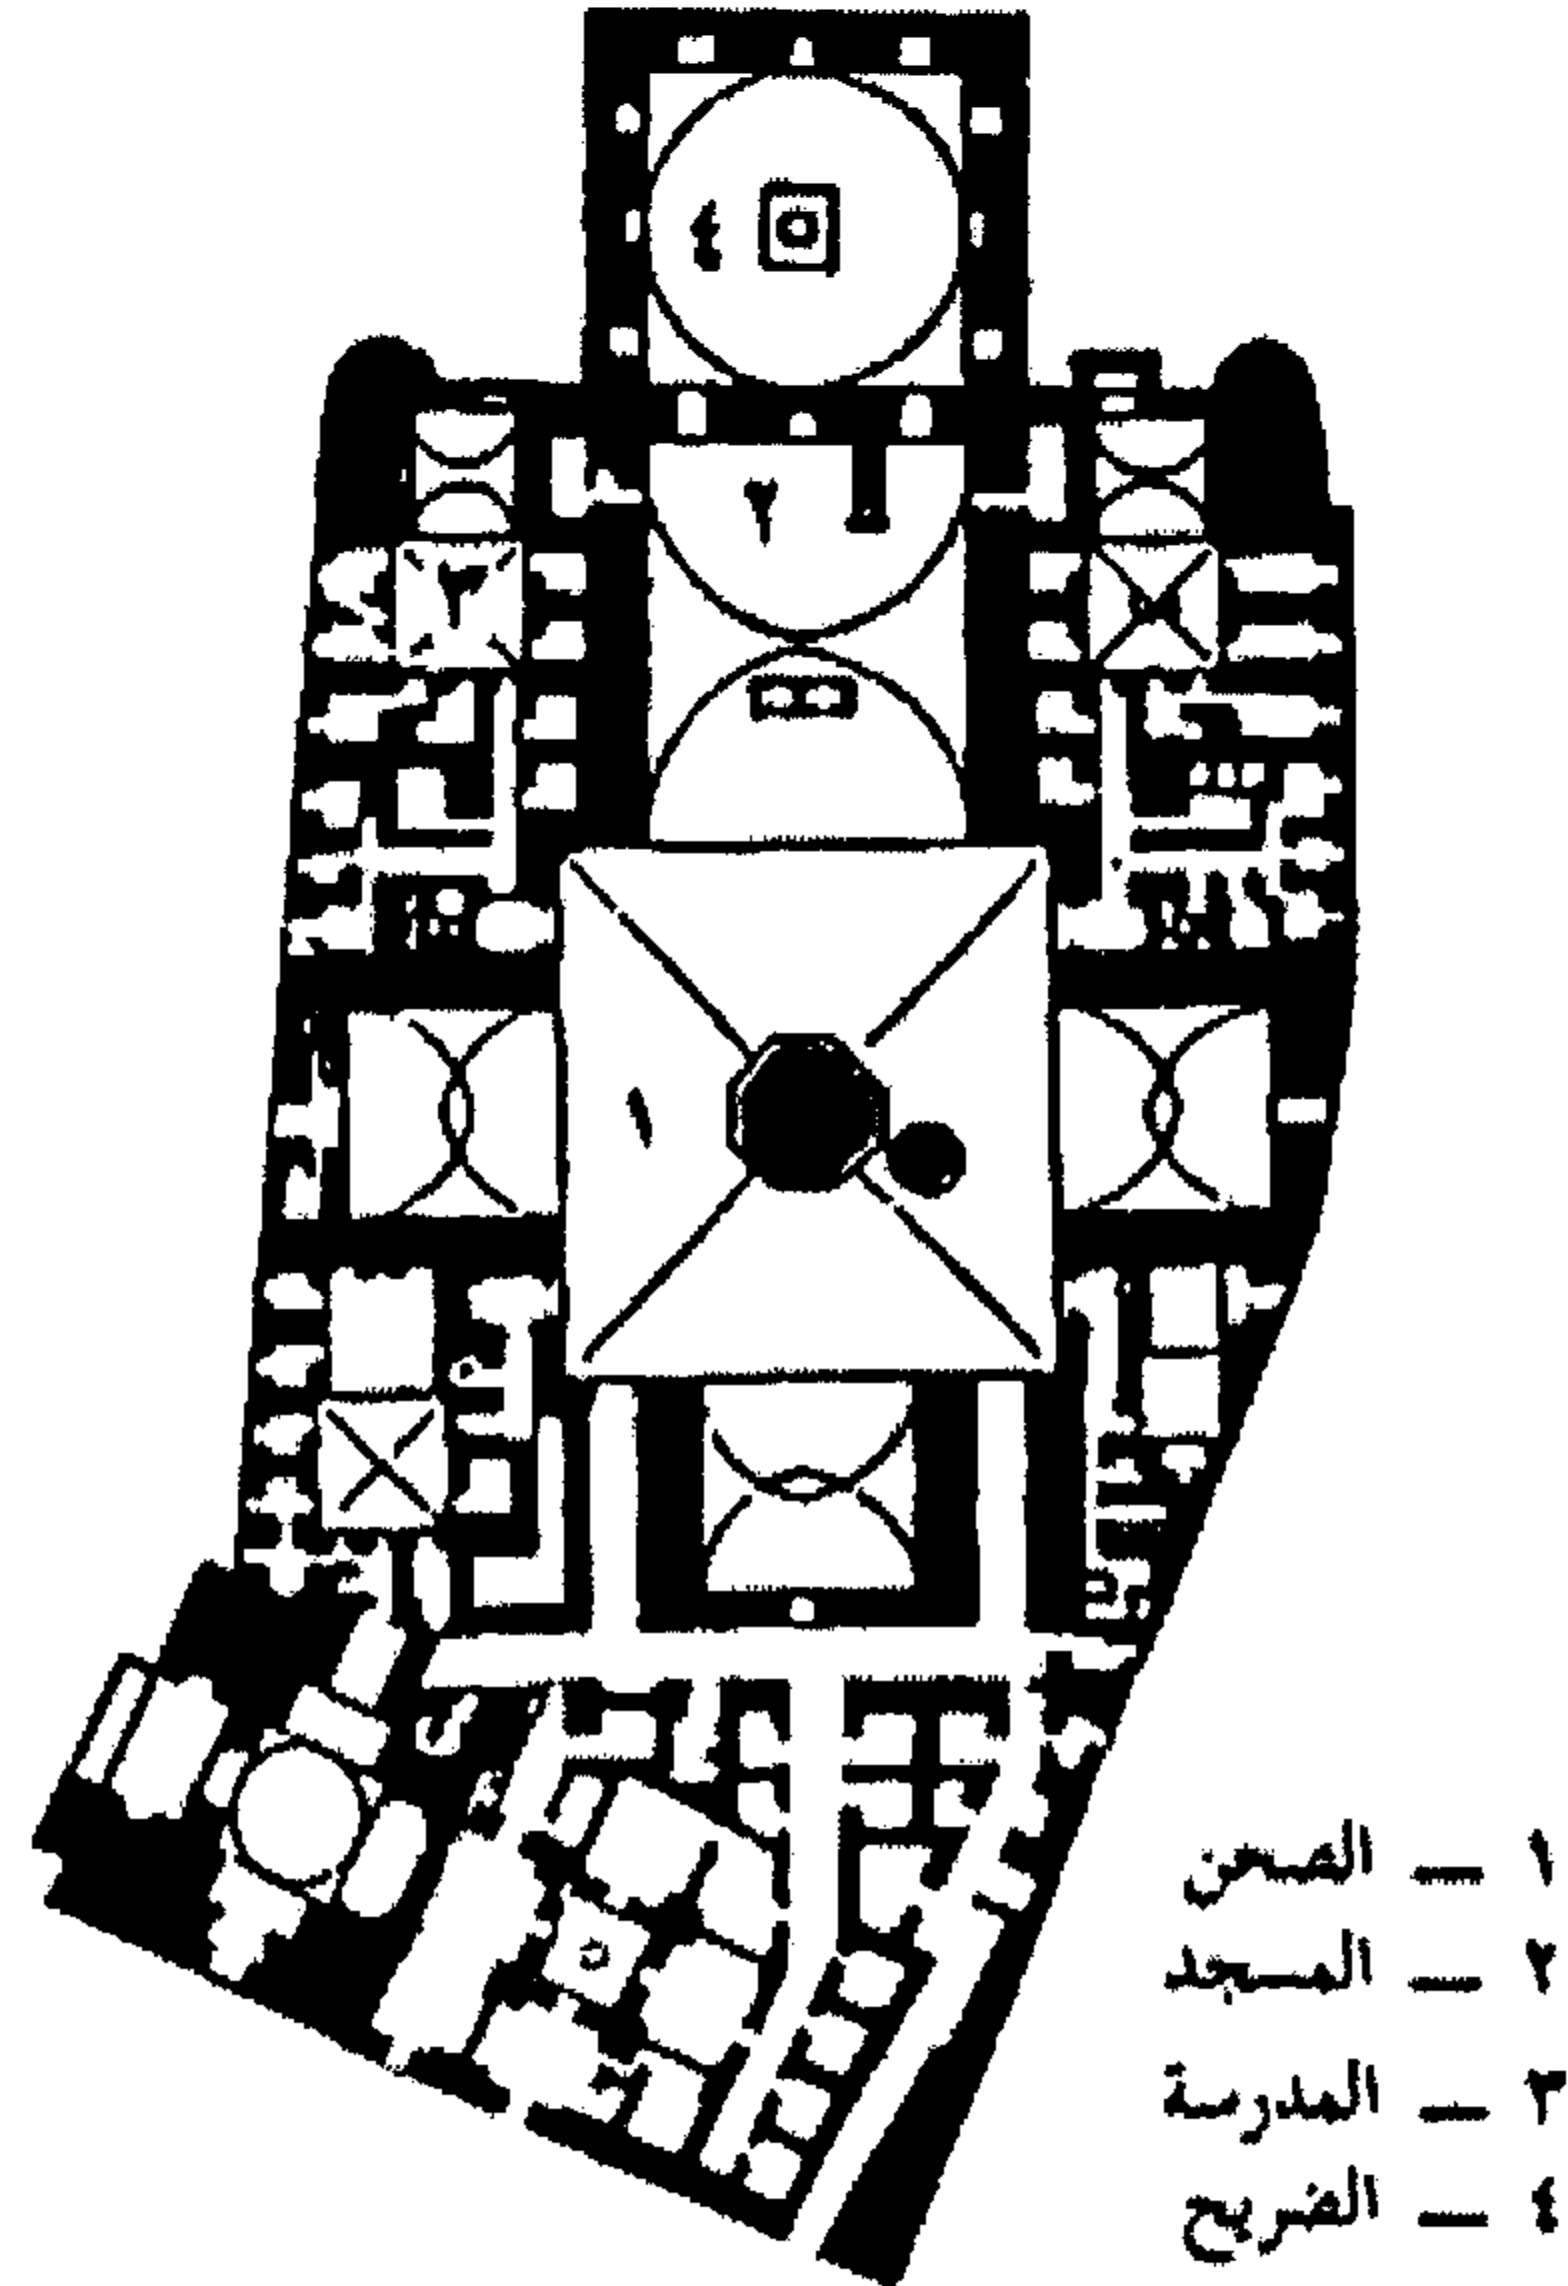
/١) مسقط أفقي لمسجد الجامع، أصفهان. إيران
